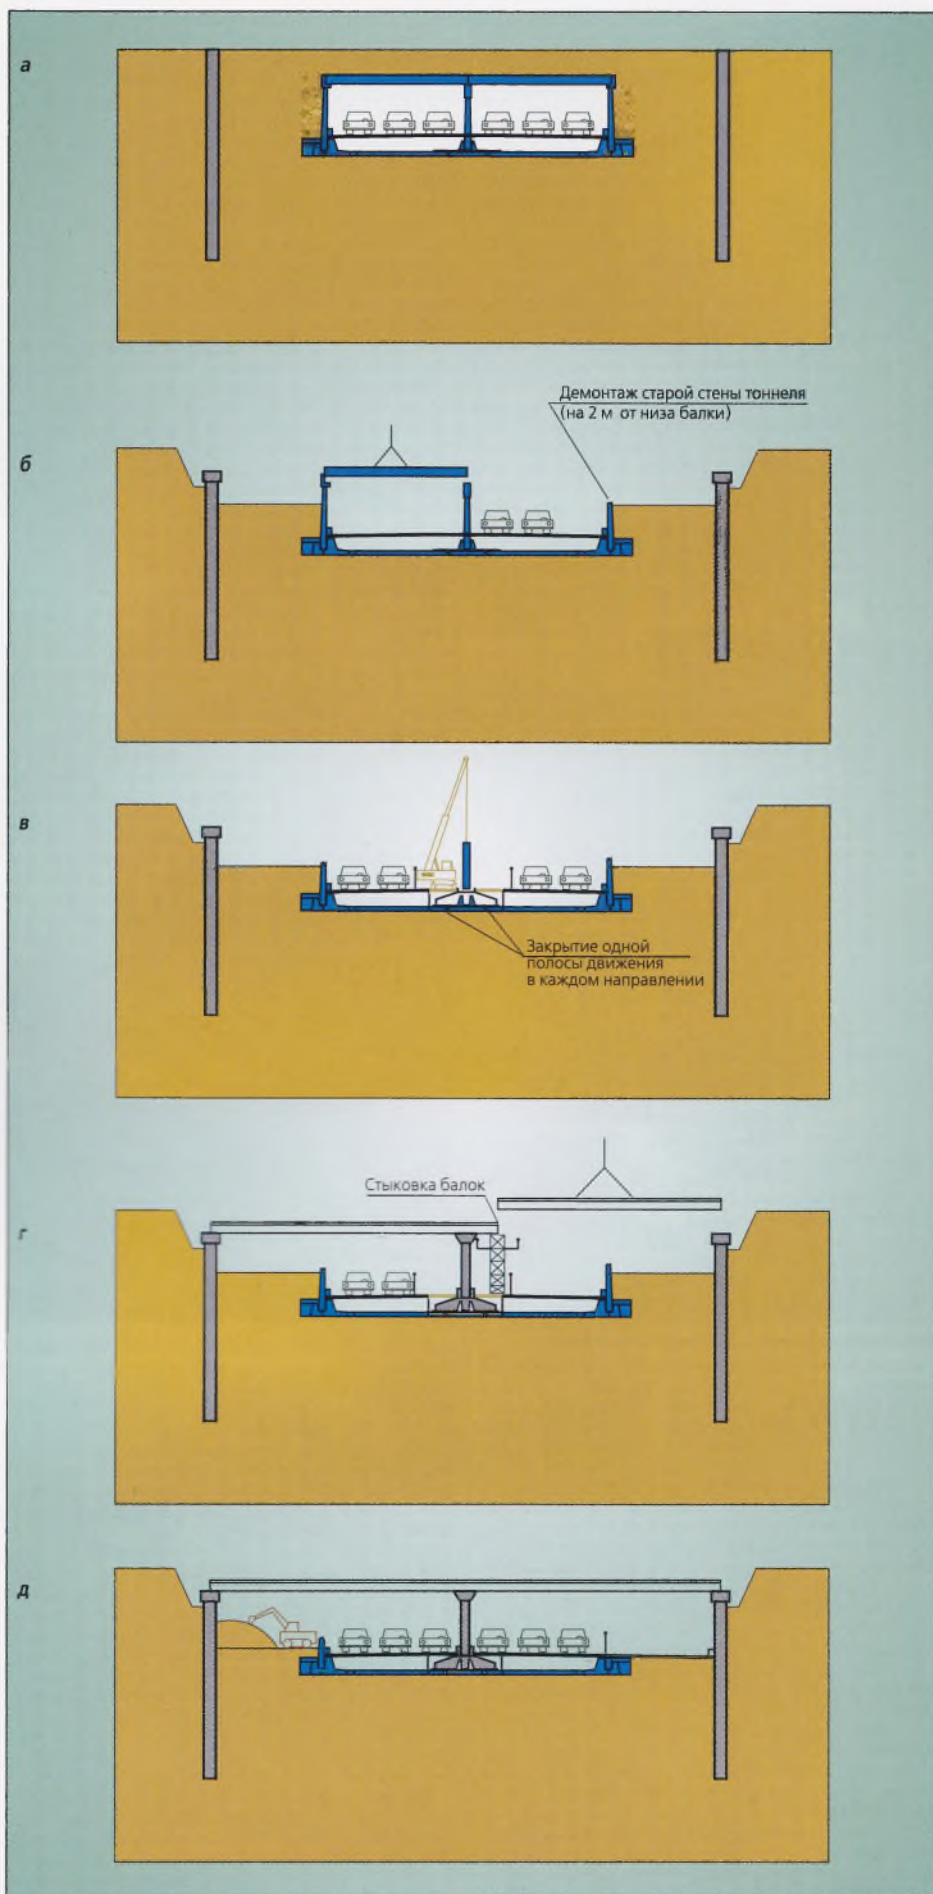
Последовательность реконструкции закрытой части тоннеля: а – сооружение «стены в грунте» из буросекущихся свай диаметром 1000 мм; б – демонтаж балок перекрытия старого тоннеля в ночное время; в – демонтаж старой и строительство новой центральной опоры; г – монтаж нового пролетного строения тоннеля в ночное время; д – разработка грунта между новой и старой стенами тоннеля, устройство водостока, дороги, архитектурной отделки
